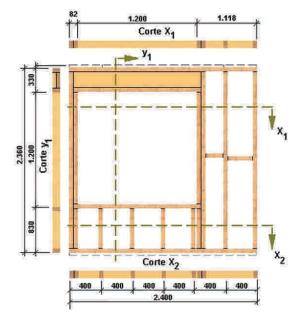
68: Elemento TSPv₁ -2400x2360a-(1)
